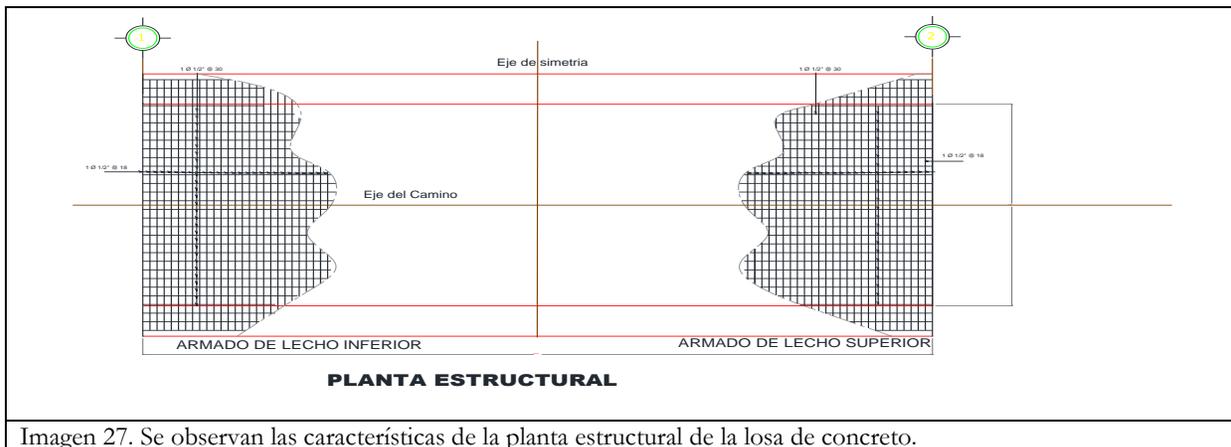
Se observan las características de la planta estructural de la losa de concreto.
